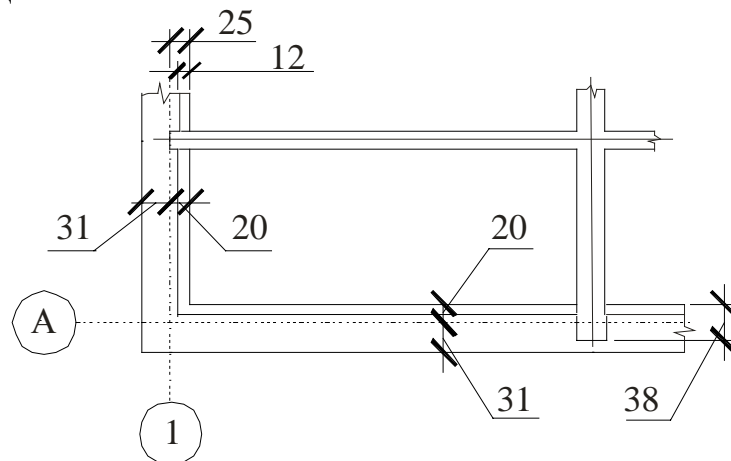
Прив'язки ділянок опирання балок на зовнішні стіни
